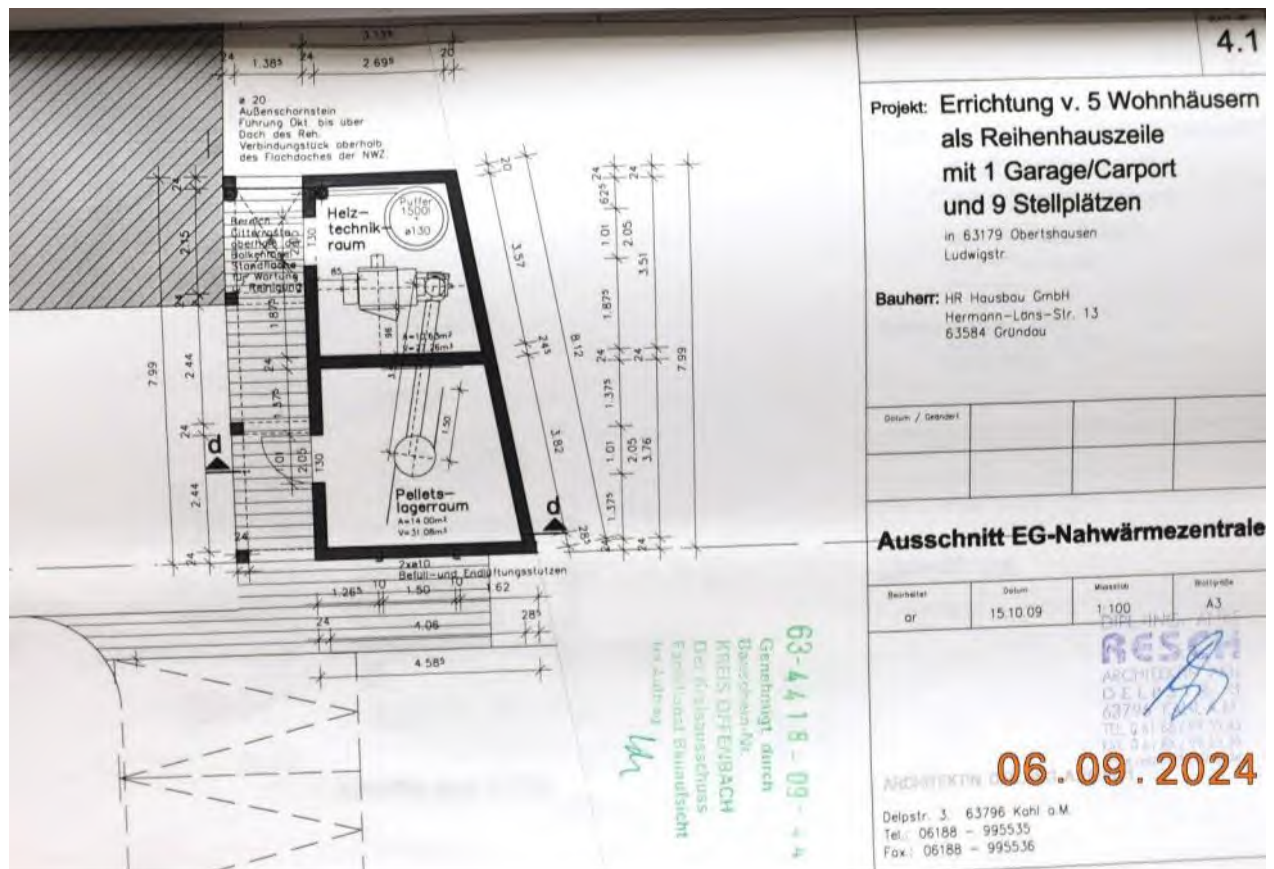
Grundrissplan Erdgeschoss der Nahwärmezentrale (aus Bauakte)
